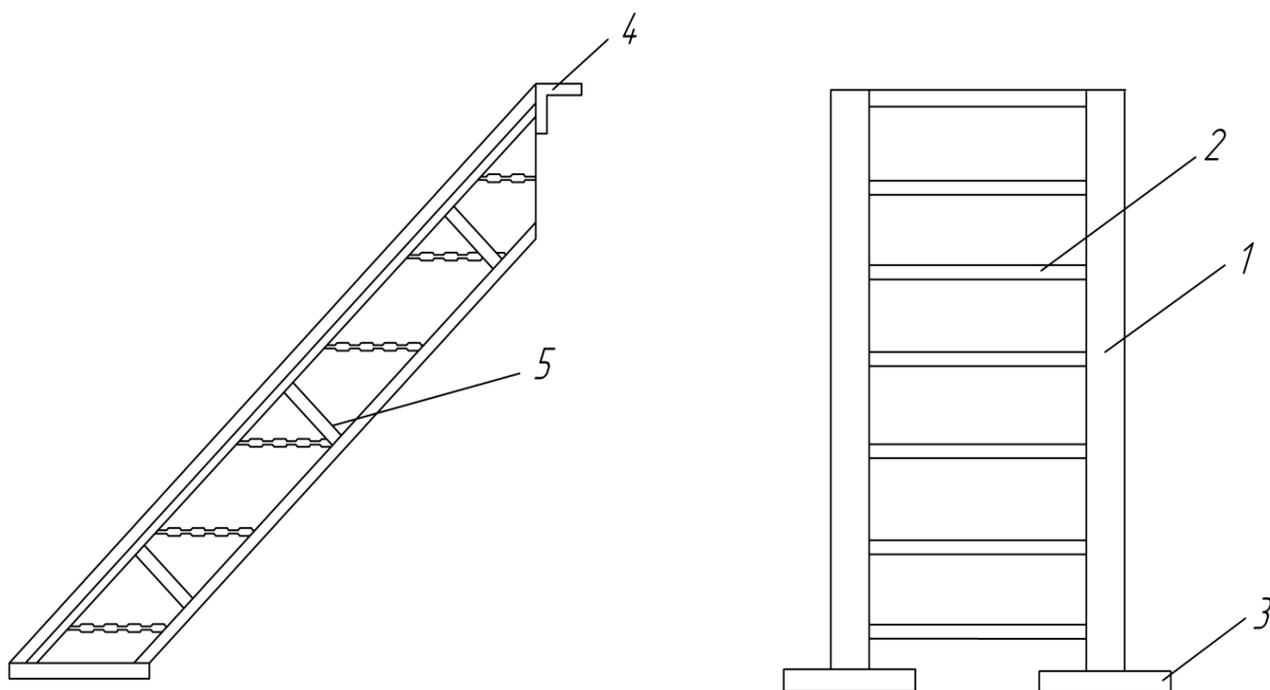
Конструкция служебной лестницы: 1 – косоур; 2 – ступень; 3 – опорная планка; 4 – опорный уголок; 5 – ребро
